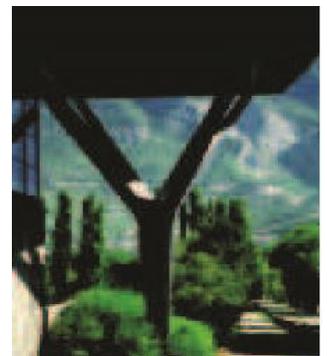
Poteau caisson arborescent du gymnase de Saint-Jean-deMaurienne (ABN Building Corporation.com)
